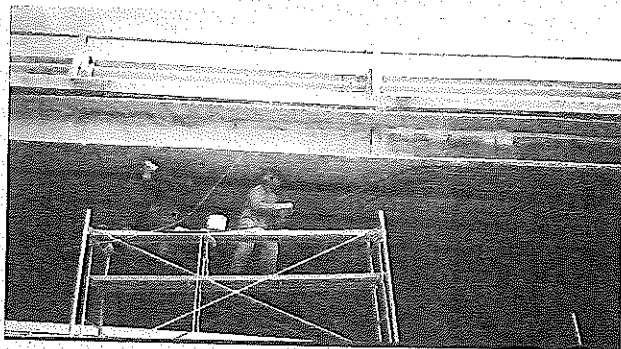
Colocación de refuerzo a flexión en viga lateral de un puente.
